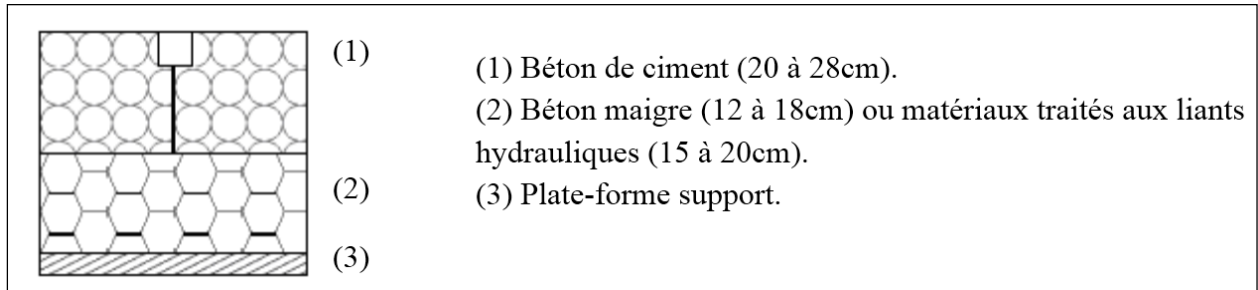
Structure d'une chaussée à dalles non goujonnées avec fondation (MEZIANI, 2008)
